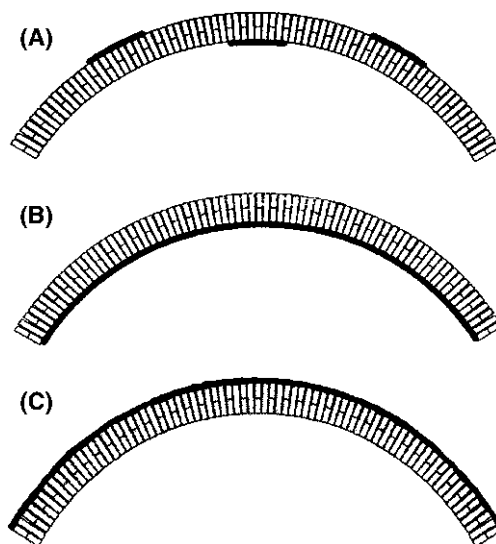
Configuração de reforço aplicado (Briccoli Bati & Rovero 2007)
